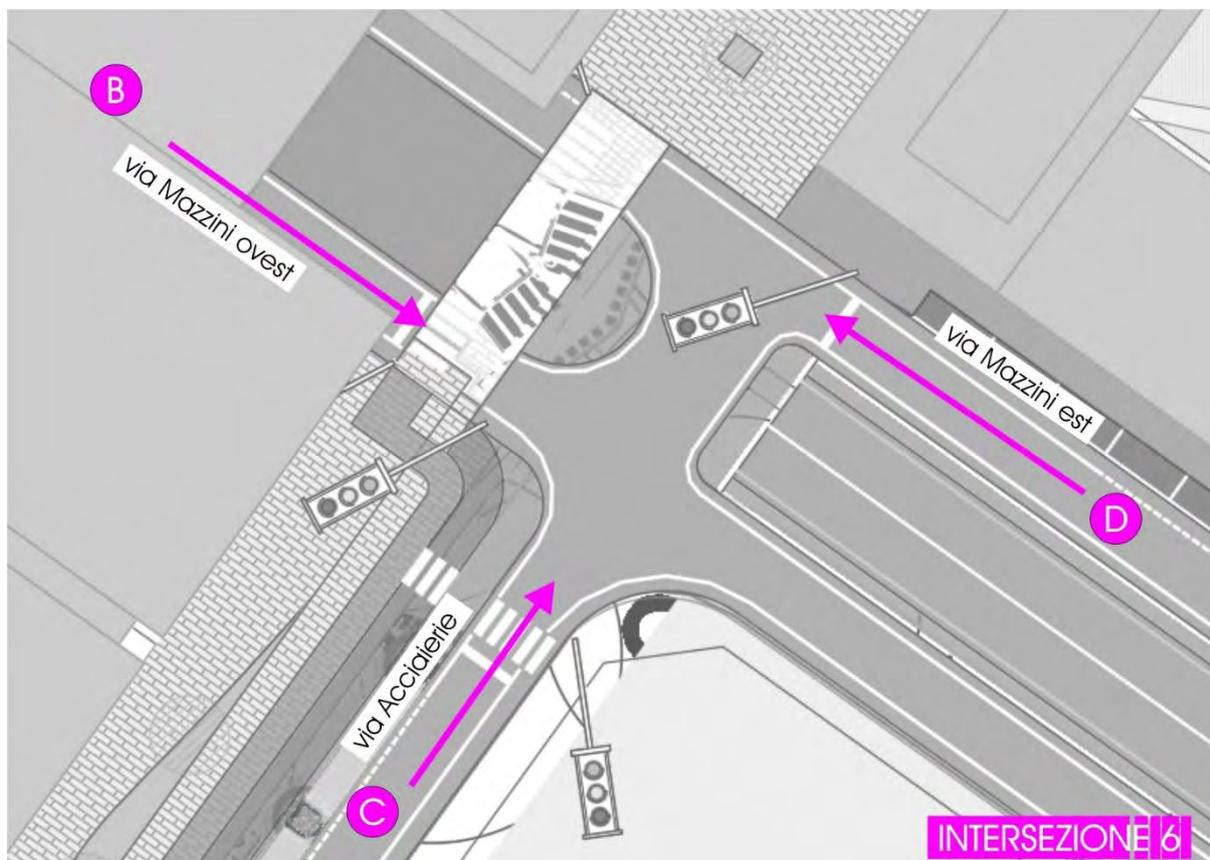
Scenario di Intervento 1 – Planimetria intersezione 6
